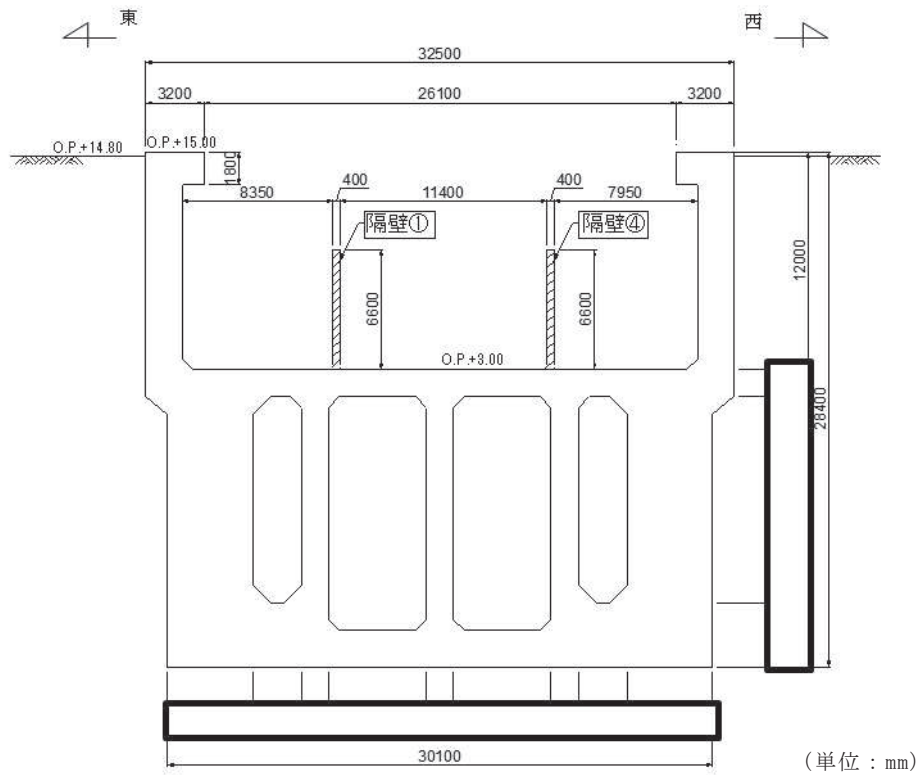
(1) 補機ポンプエリア断面図 (①—①断面)
